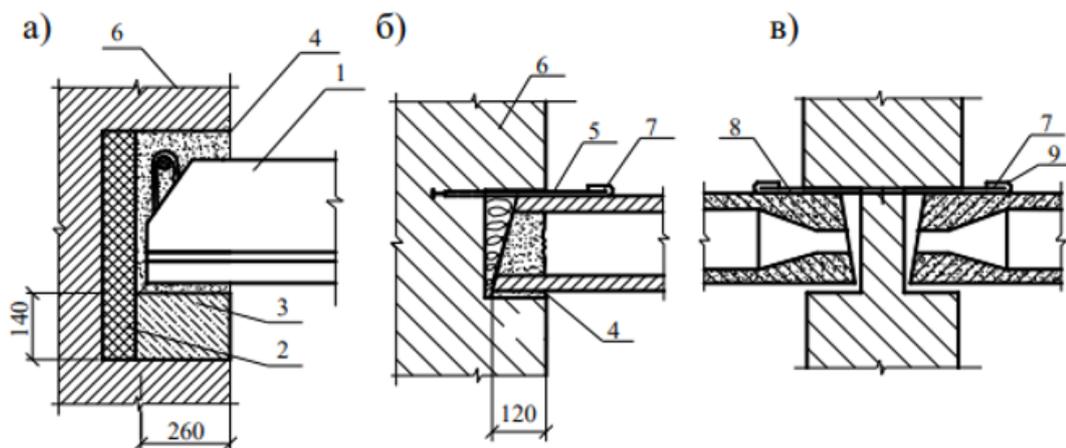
Опорні вузли залізобетонних балок та плит перекриття:
